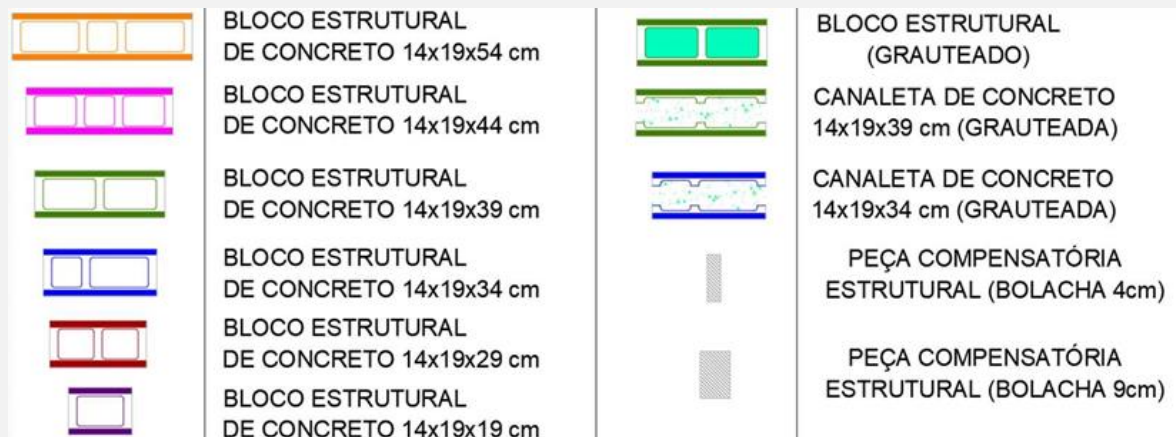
Blocos utilizados na construção da edificação. Fonte: Autores.
